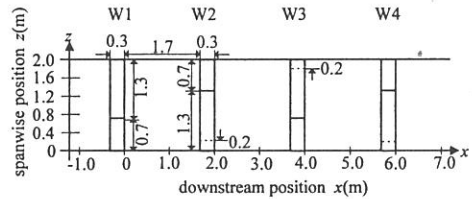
対象魚道の平面・縦断面図(第1~第4隔壁間)
